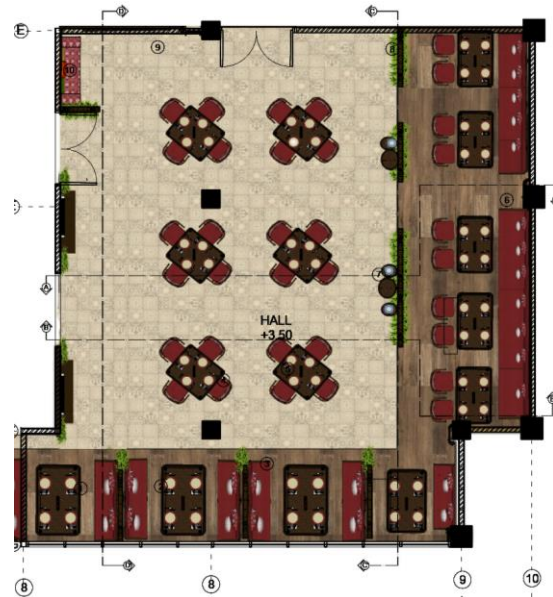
Detail Elemen Estetis Terpilih Ruang Makan Sinta
